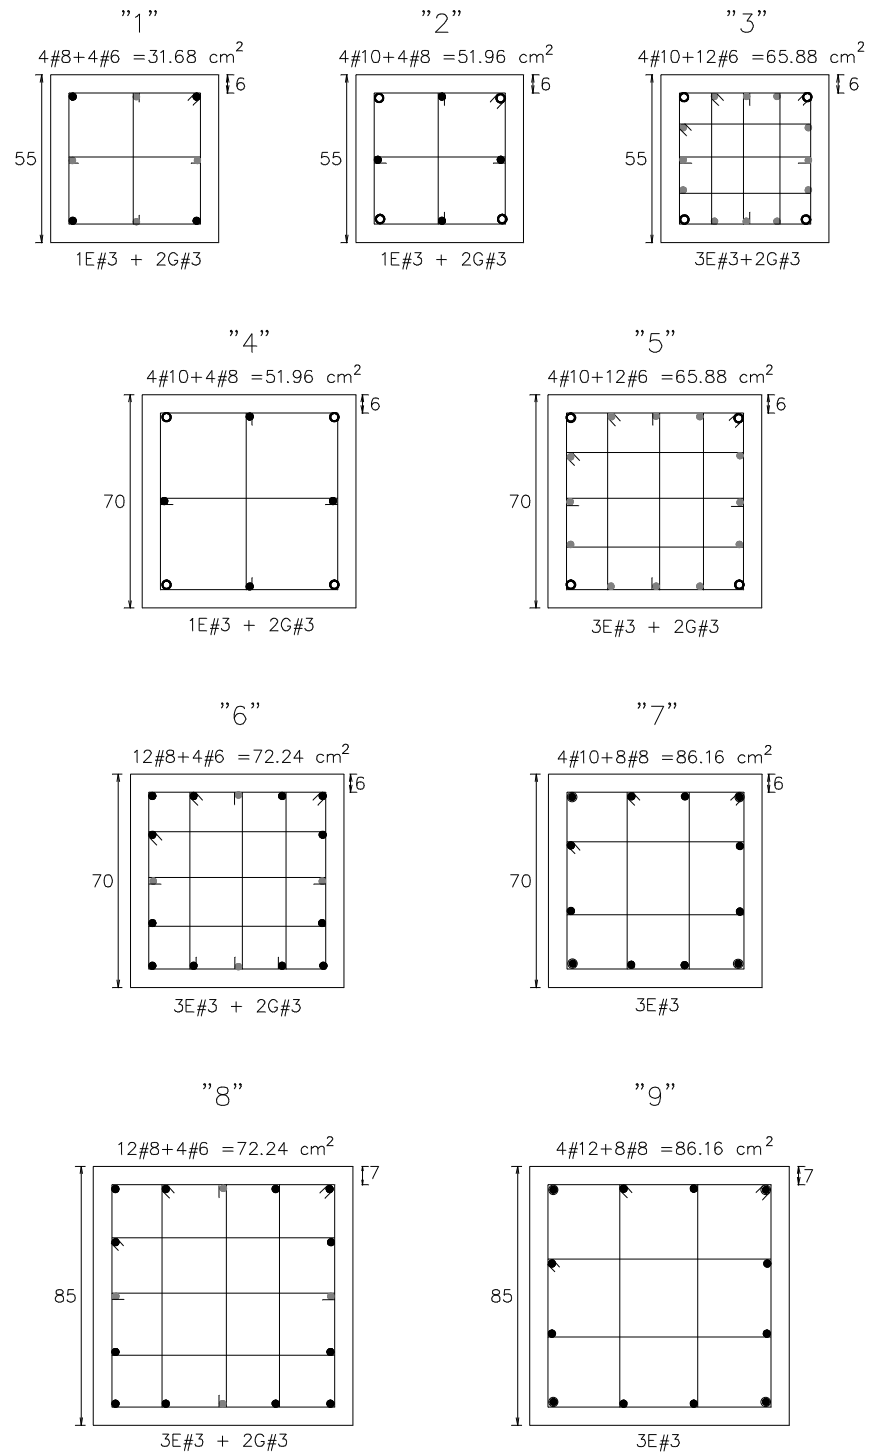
Tipos de armados propuestos para las columnas del eje 2, estructuras de 17 niveles diseñadas en zona III (RDF-93 y RDF-04)
